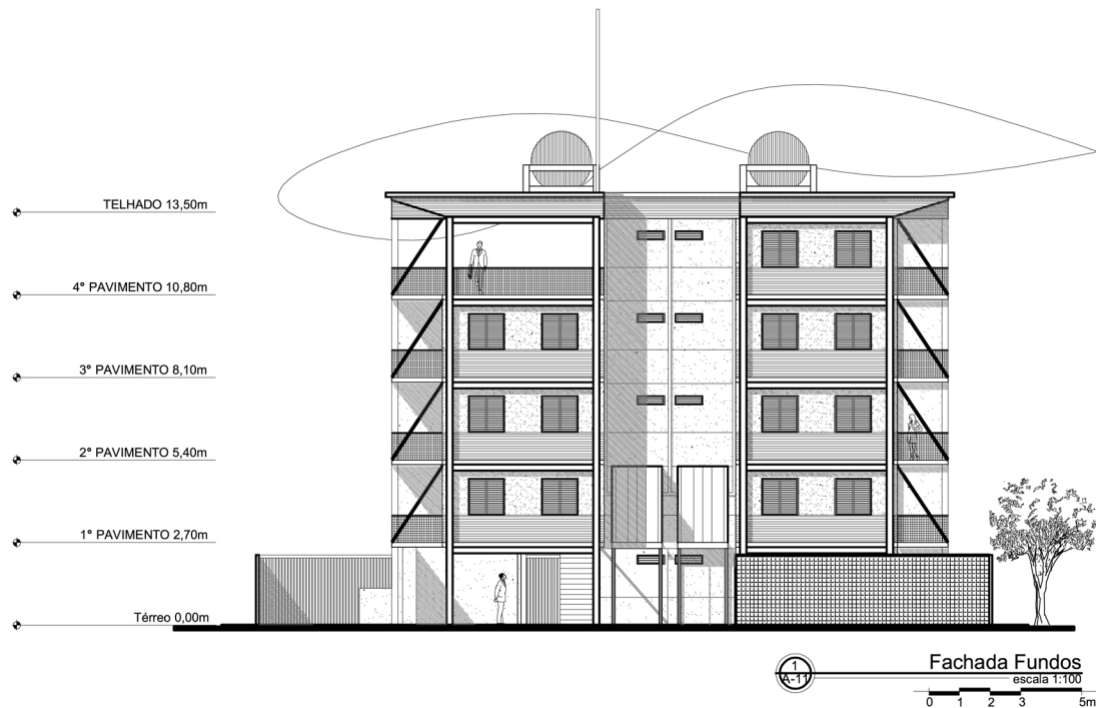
Fachada fundos. Fonte: Arquivo do autor
